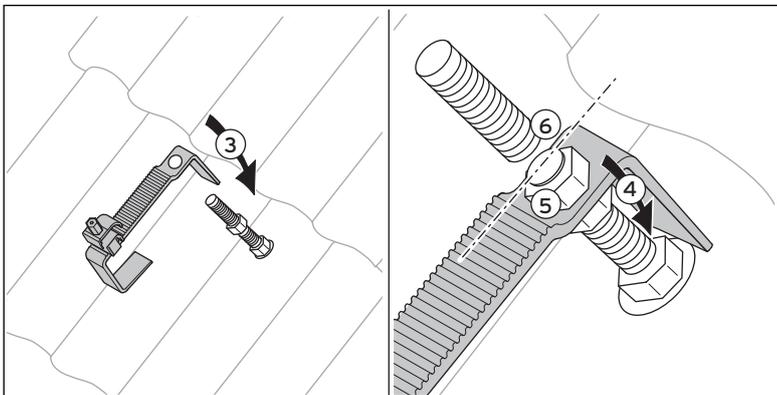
Dachanker auf dem Dachsparren befestigen
